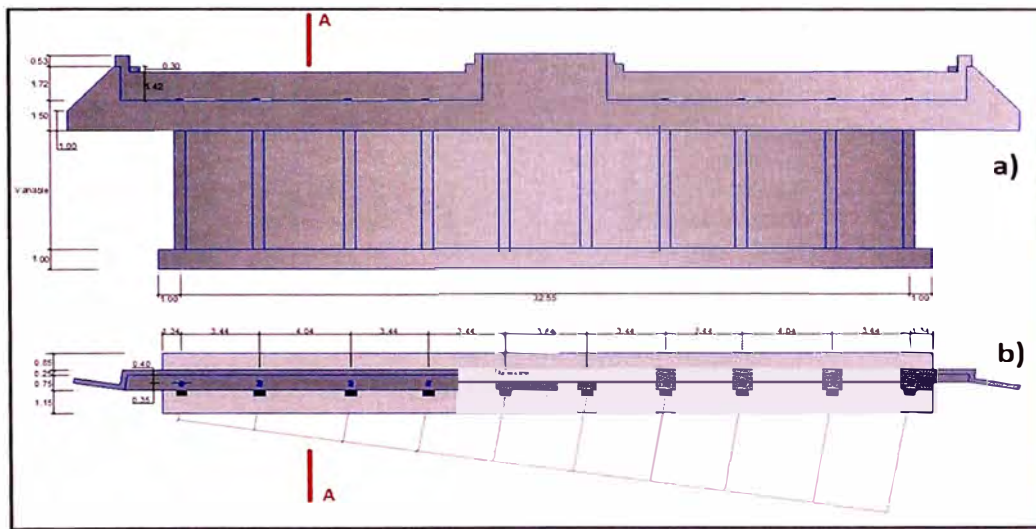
a) Elevación y b) Vista en planta del estribo.
